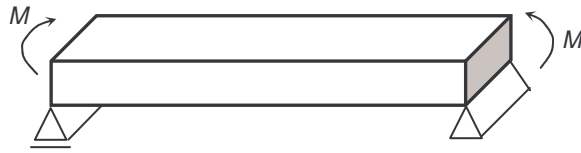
Schéma de la poutre sur des appuis simples en acier
